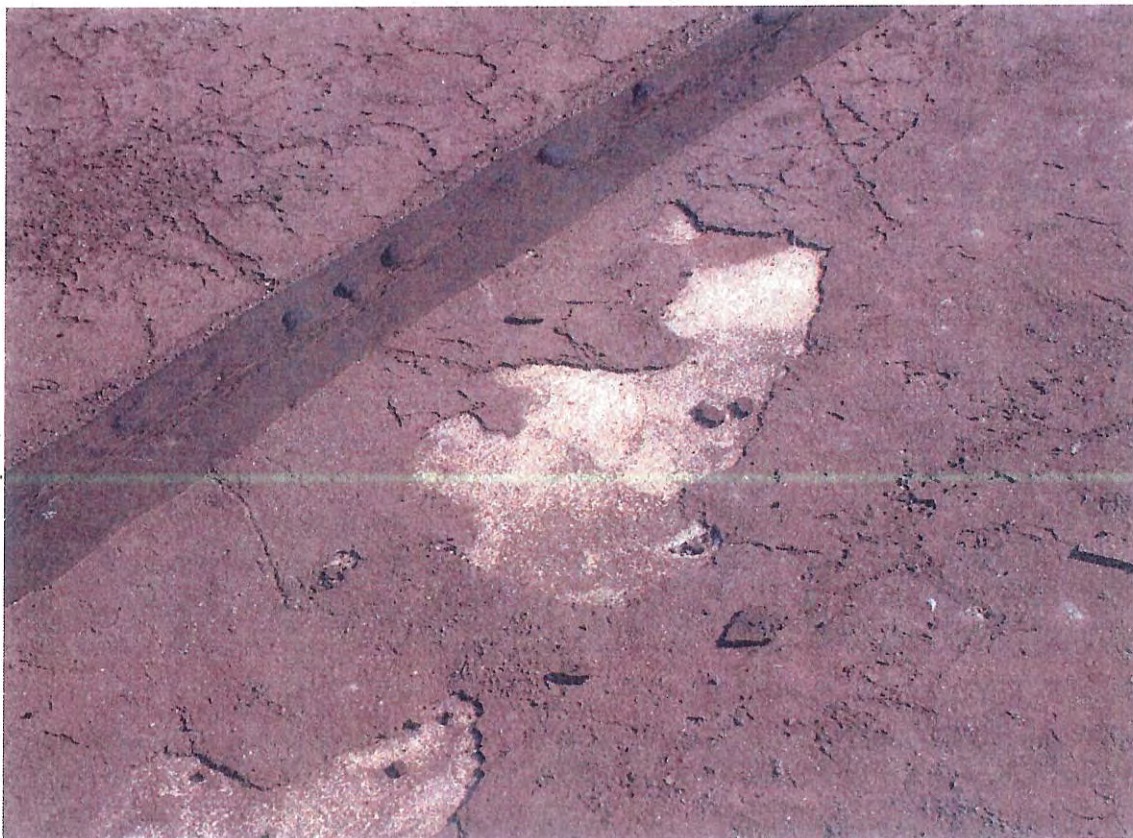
Die vor Ort gegossenen Betonplatten sind flächendeckend mit einer Bitumenversiegelung (Probe P 2, 0,5 cm) versehen.
